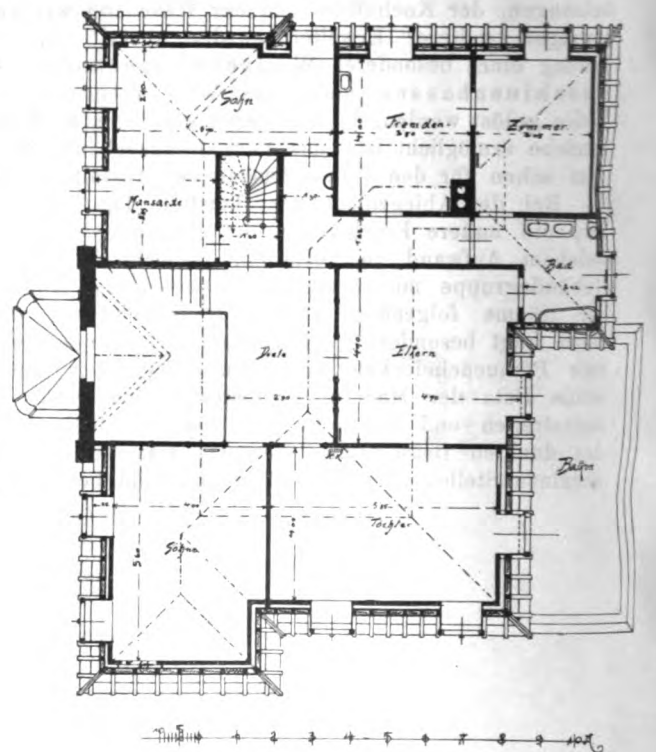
Landhaus in Oberursel; Dachgeschoß.
